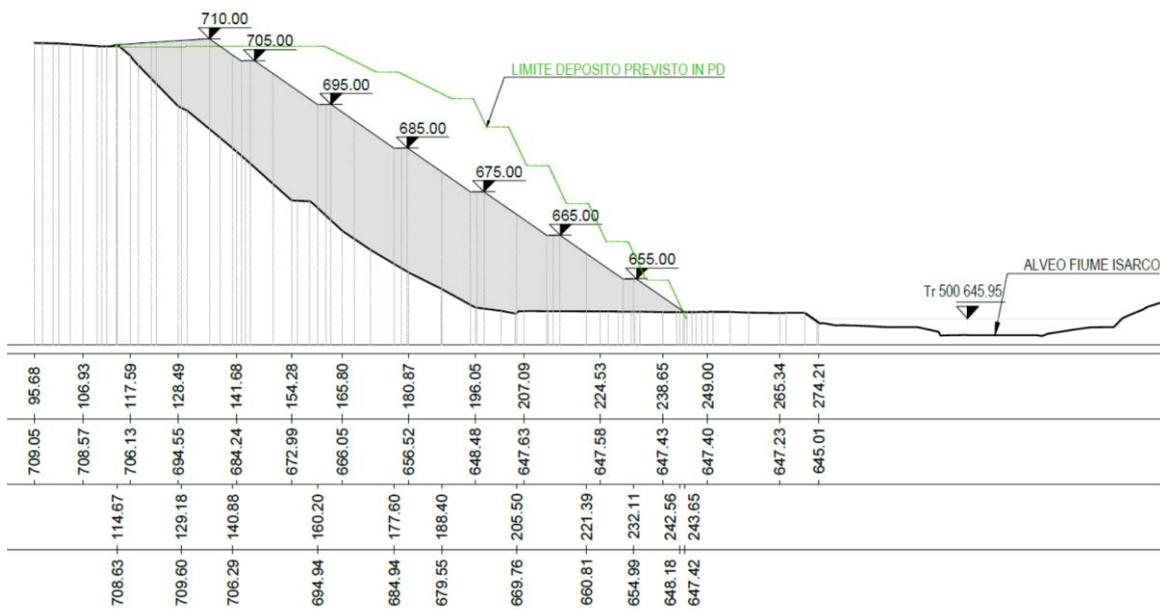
Sezione di raffronto fase finale PD – PE
